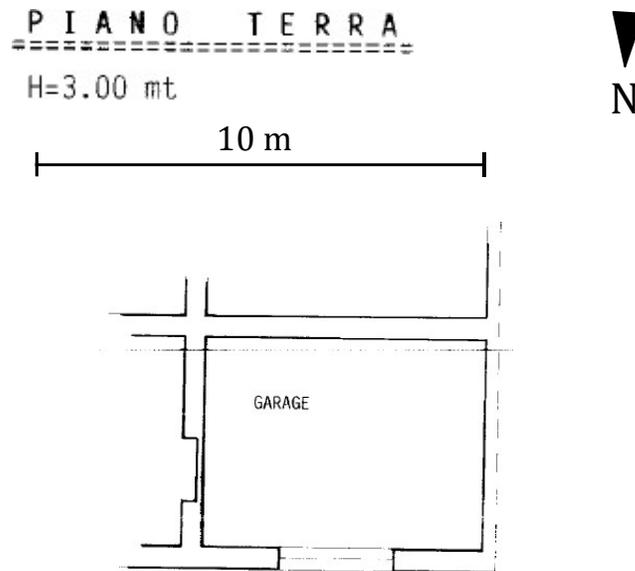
Estratto Planimetria Catastale - Autorimessa (Ricovero Animali) NCEU Foglio 29, Part. 1434 sub. 1
